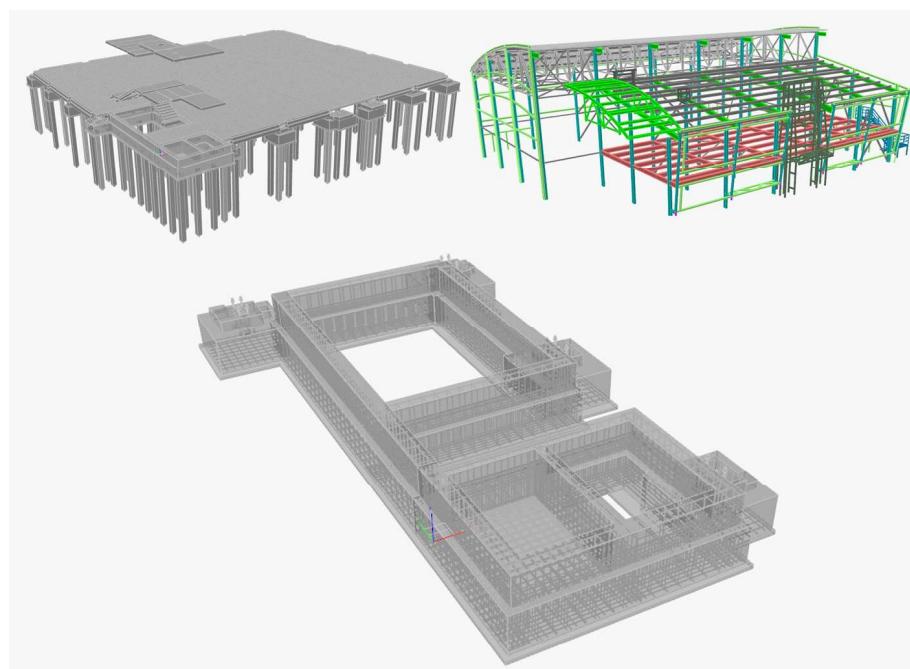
Проектирование железобетонных и металлических конструкций ФОК в программе nanoCAD BIM Конструкции
